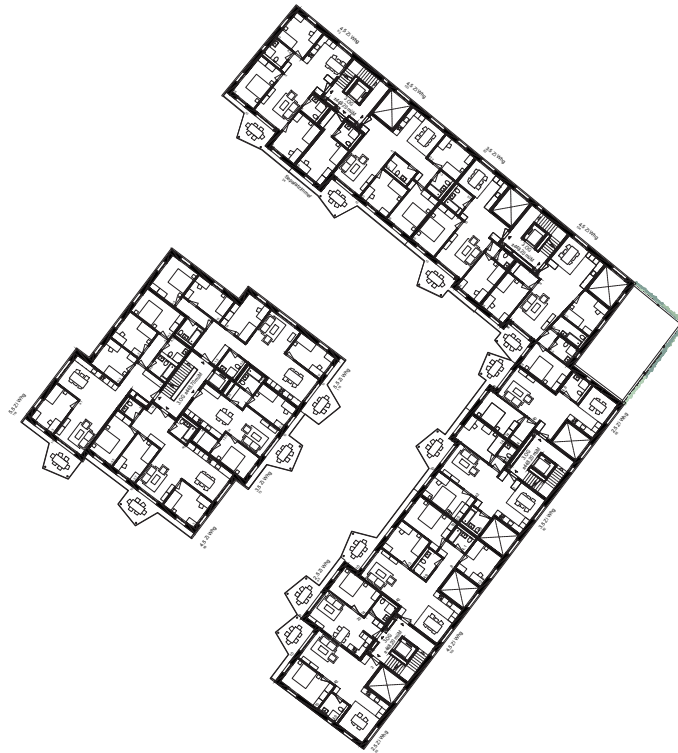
sobremesa: Grundriss Obergeschosse (exemplarisch)
